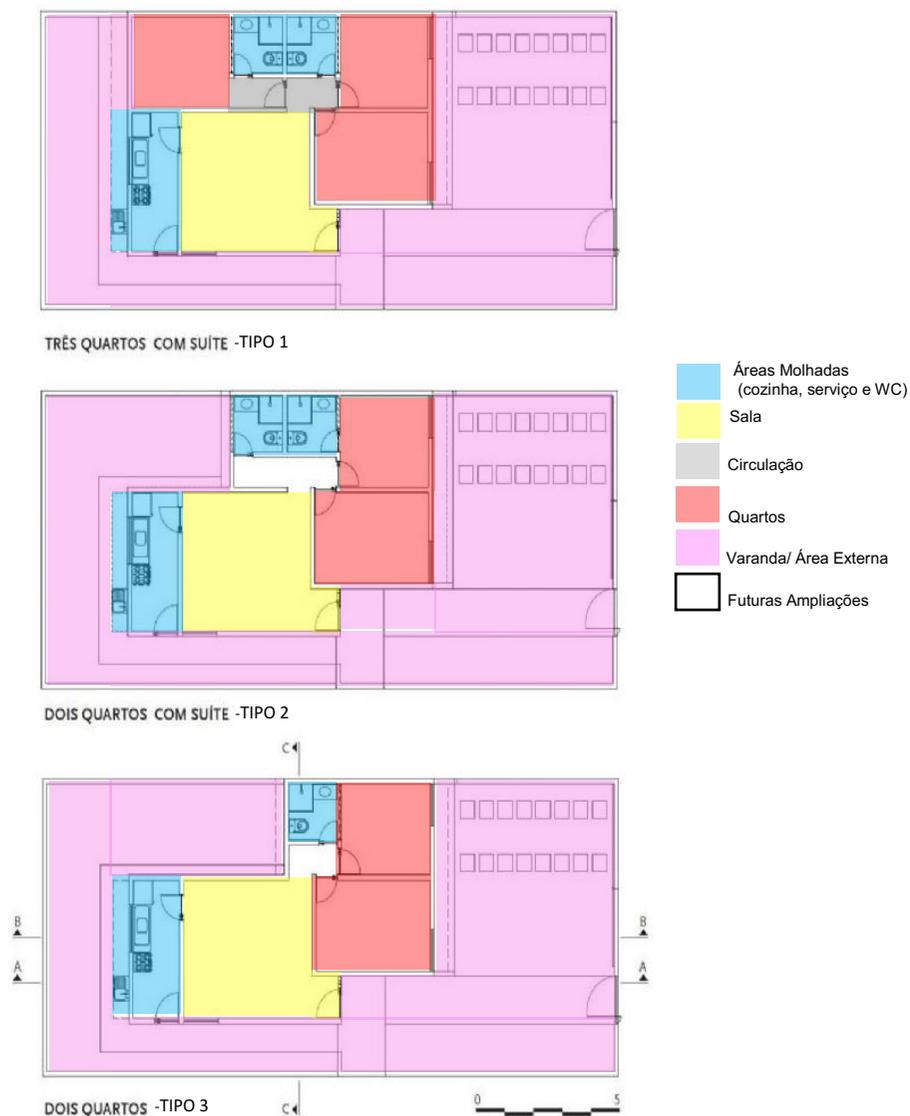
Zoneamento das tipologias arquitetônicas (Fonte: SOUZA, Maressa Fonseca 2014, modificados pelo autor)
